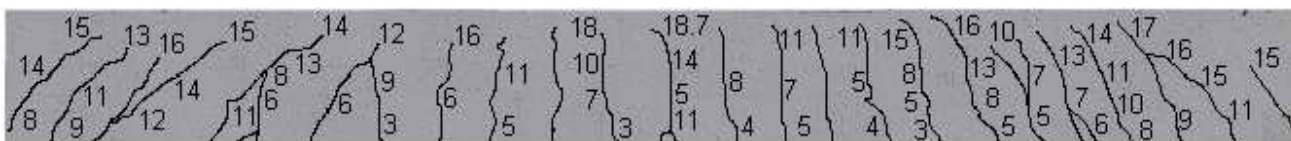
Detalhe do panorama de fissuração da viga 1
